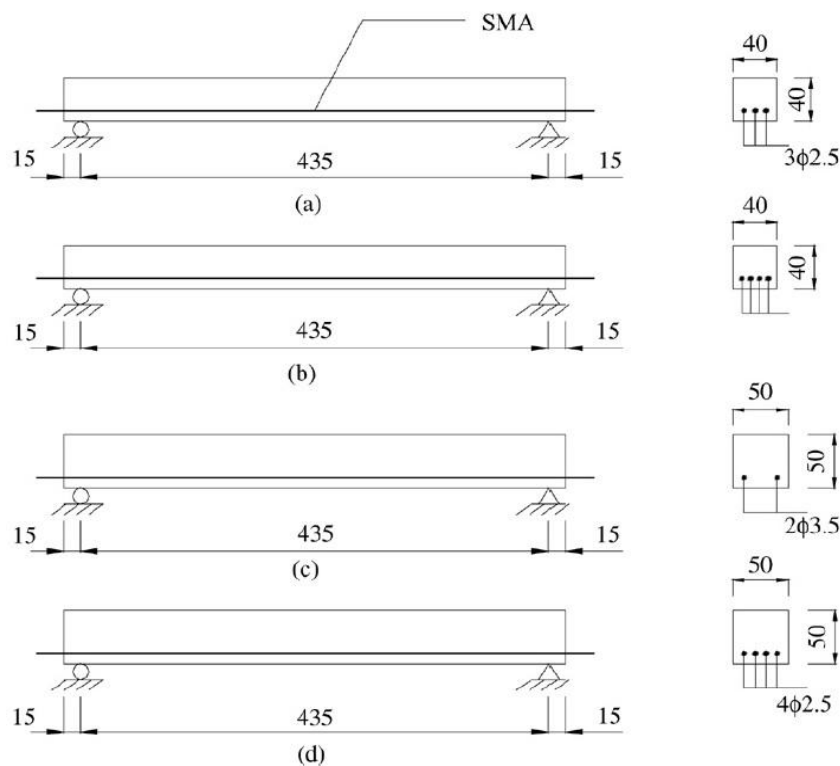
Geometria das vigas ensaiadas por Deng et al. [21]
